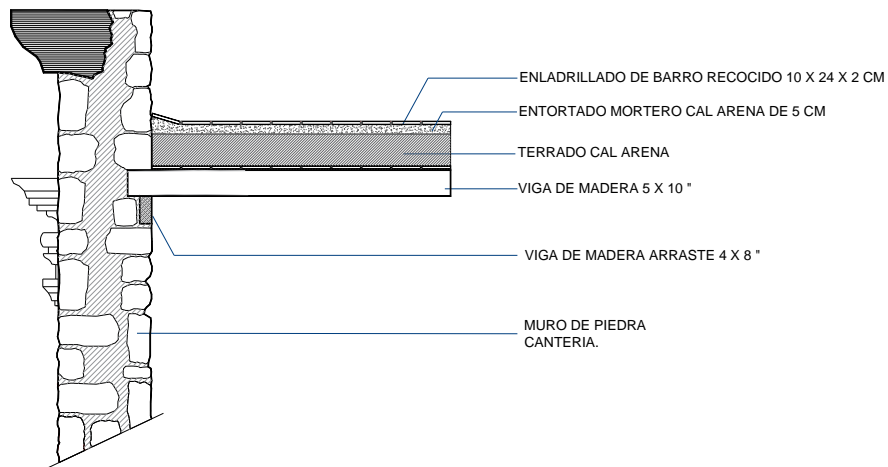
Detalle No. 1 vista del corte de la cubierta mostrando la viguería, el enladrillado y el terrado.
